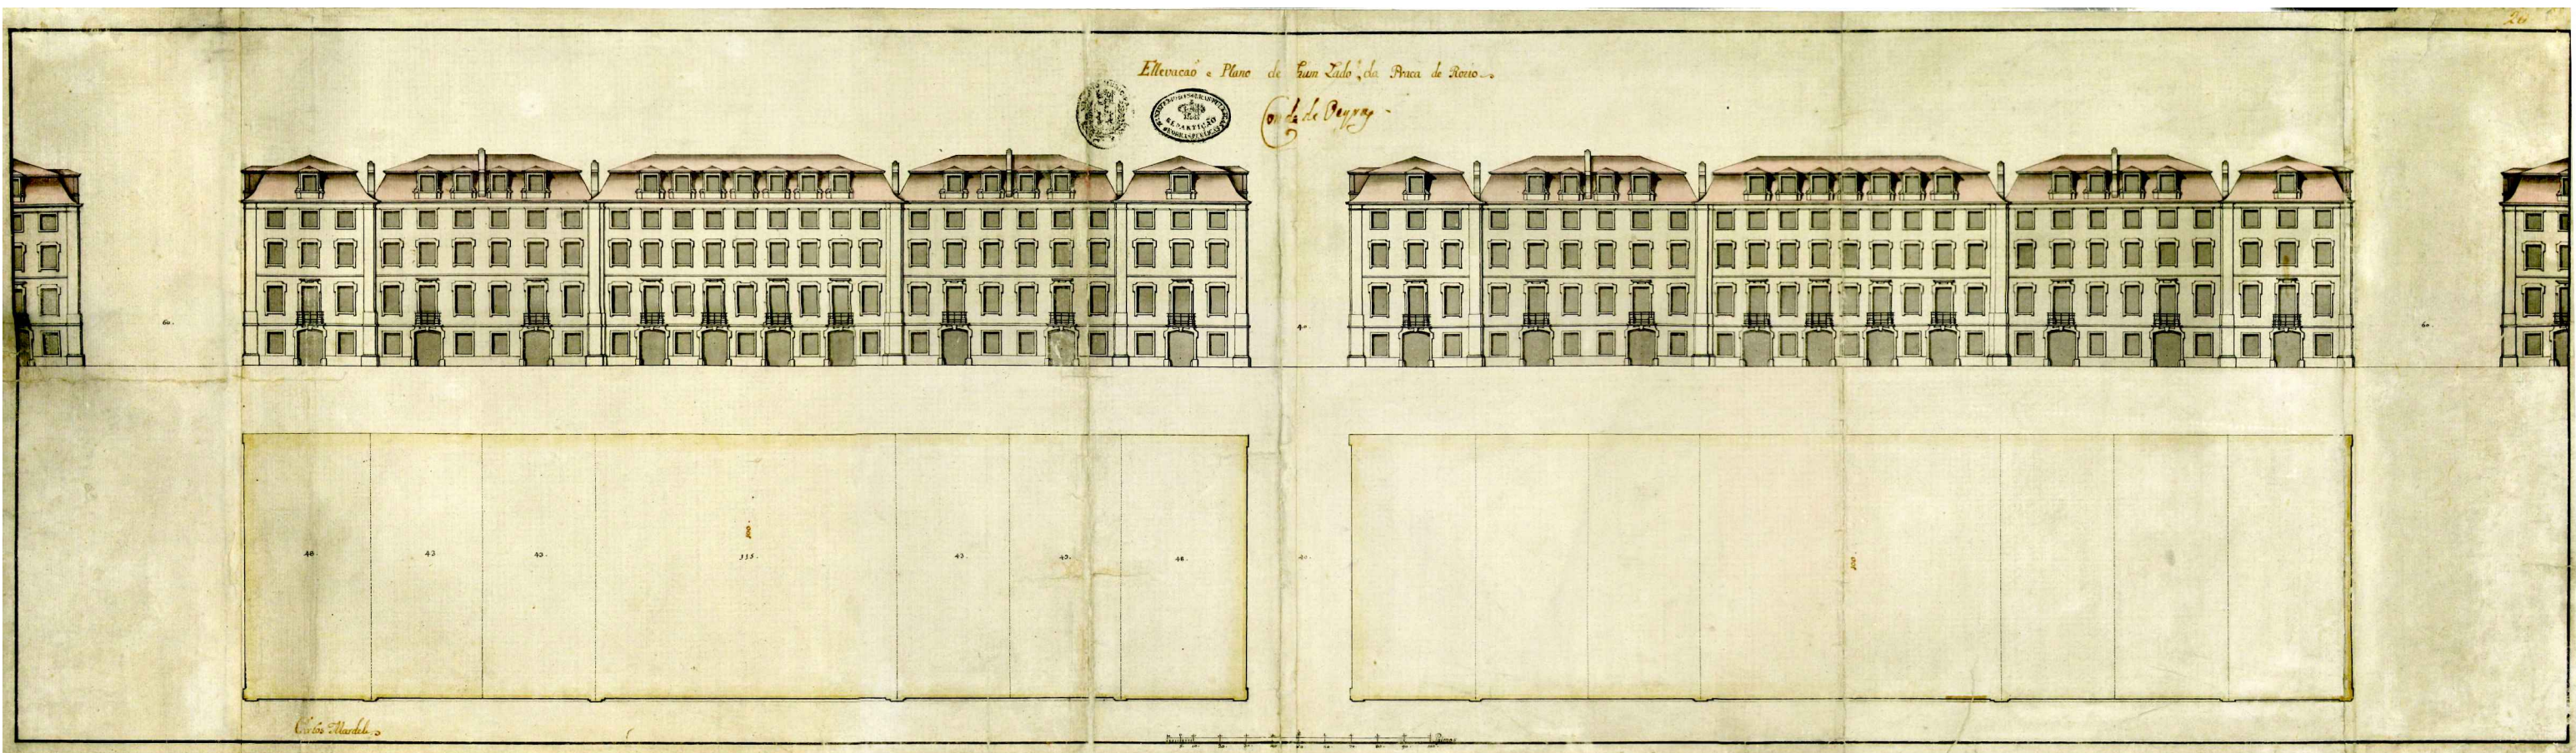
Proyecto para las dos manzanas que definen el lado occidental y el oriental de la plaza, separadas por una travessa con 40 palmos de anchura. Fachadas y planos; parcelas con profundidad de 100 palmos, modulación del frente con 48 pm + 43 pm + 43 pm + 115 pm + 43 pm + 43 pm + 48 pm. Firmado por Carlos Mardel y el conde de Oeiras.
